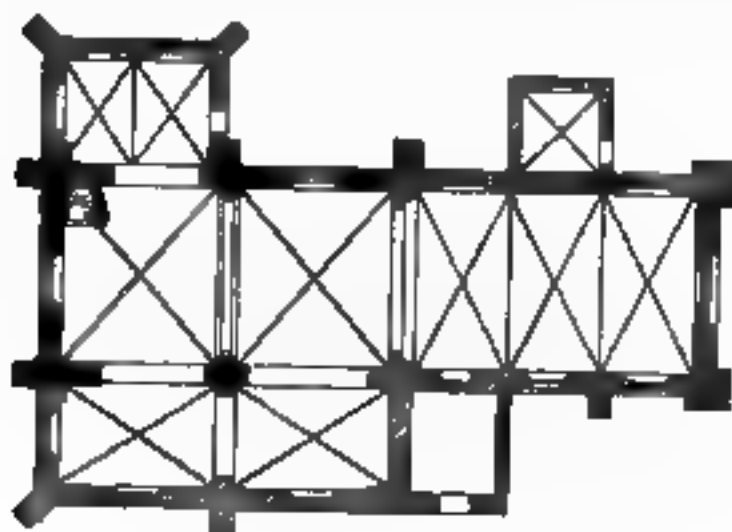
Grundriss der Kirche zu Klippleff
